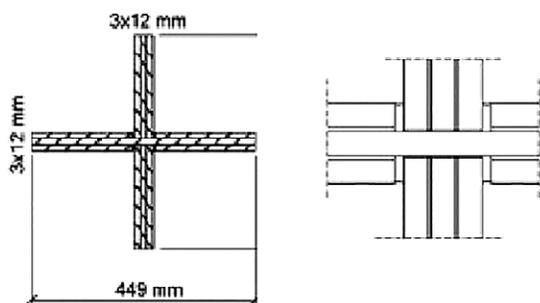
Сечение крестообразных стеклянных колонн [1]
